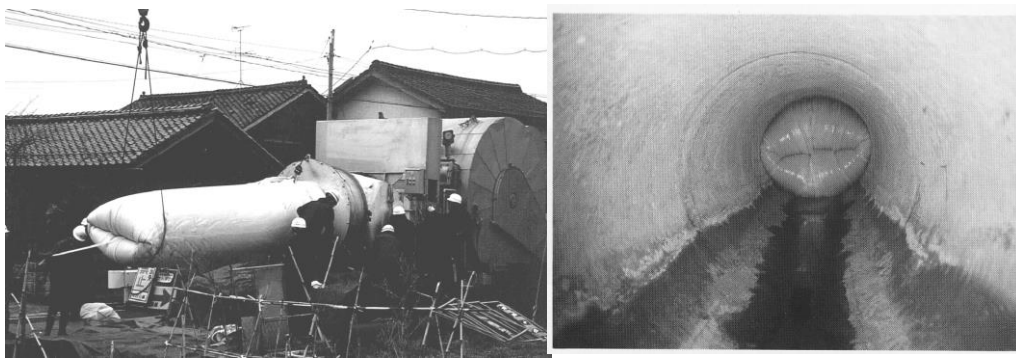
反転工法（熱硬化タイプ）の施工状況
